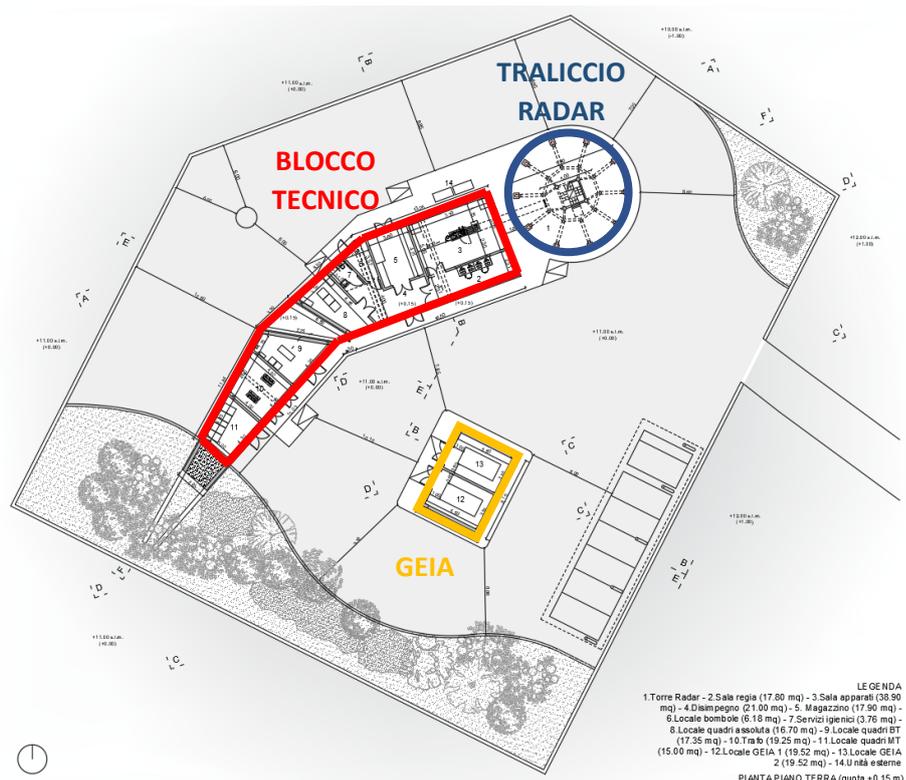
Stralcio pianta piano terra con individuazione delle funzioni.
